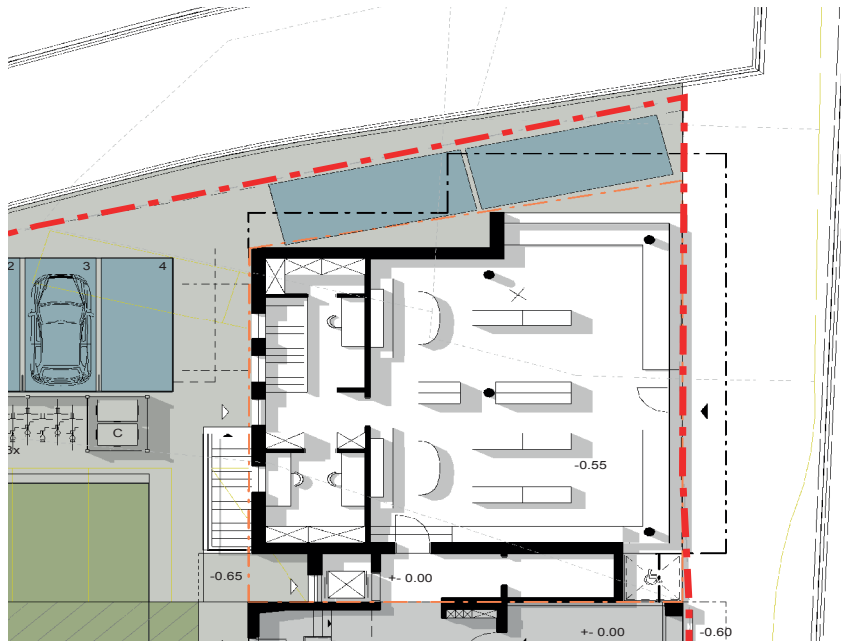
Konzeptplan Erdgeschoss mit auskragenden Obergeschossen (schwarze Strichpunktlinie) sowie bestehender Baulinie (rote Strichpunktlinie, vgl. Kapitel 2) (Konzept: Atelier Marti, Unterseen)
